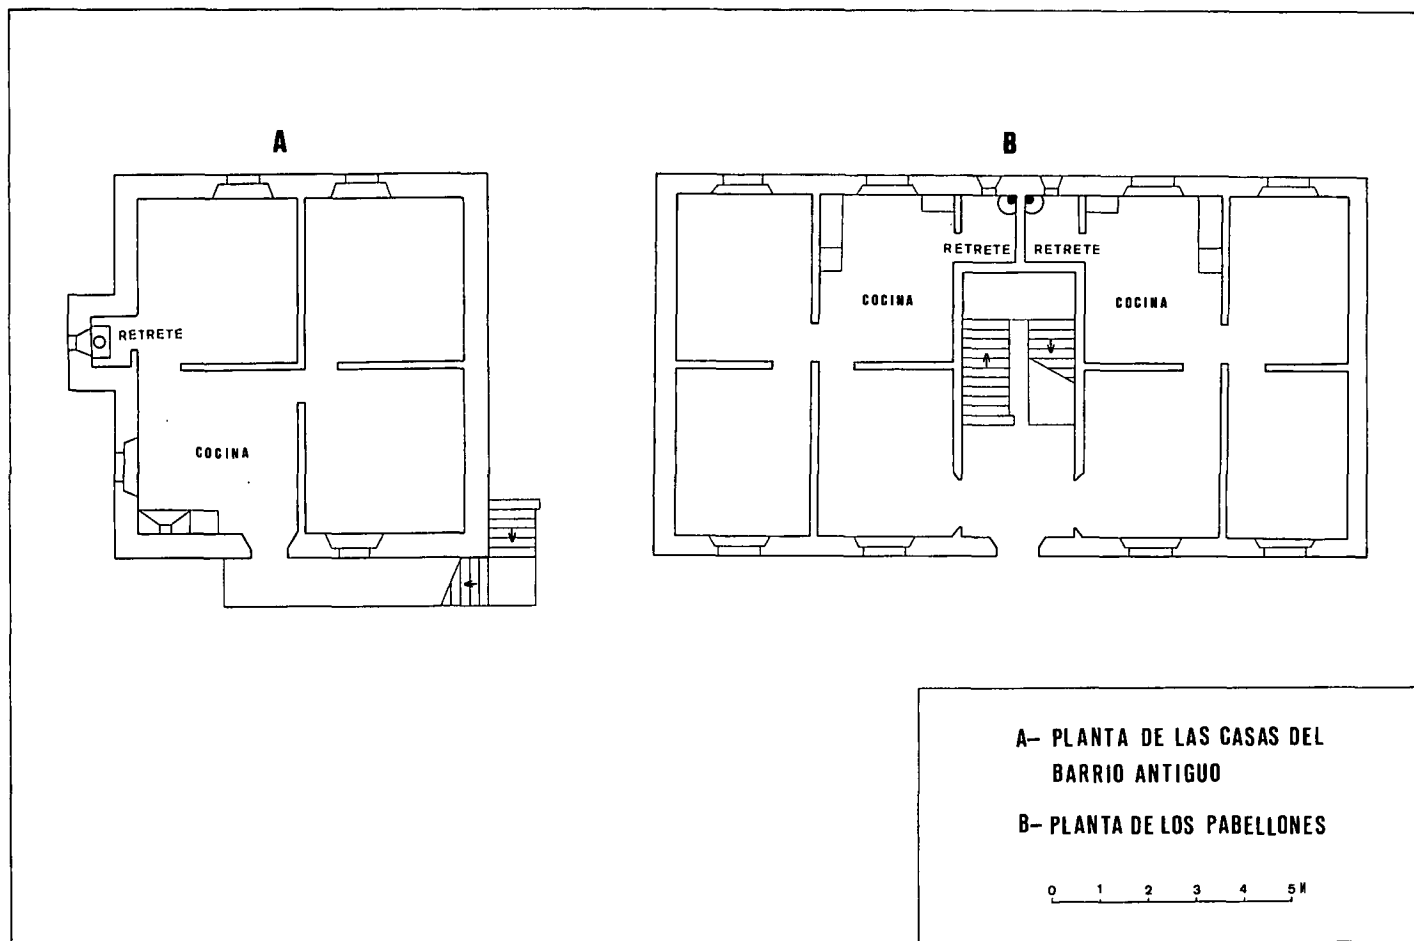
Planta de una vivienda del Barrio Antiguo. Planta de los Pabellones.
